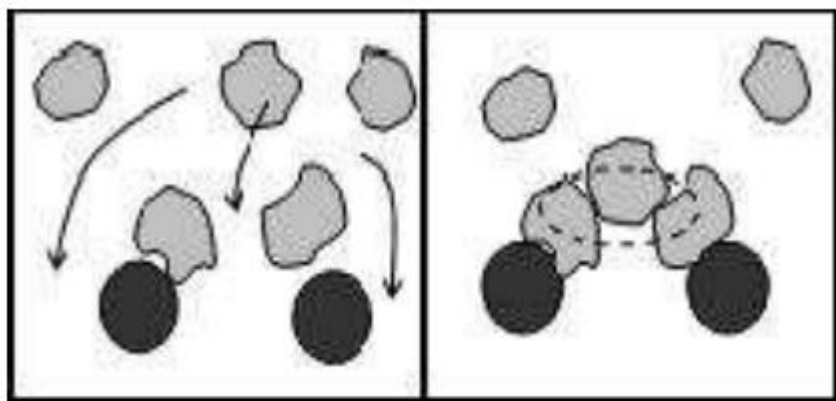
représentation en plan d'un blocage de granulats à travers deux armatures.
